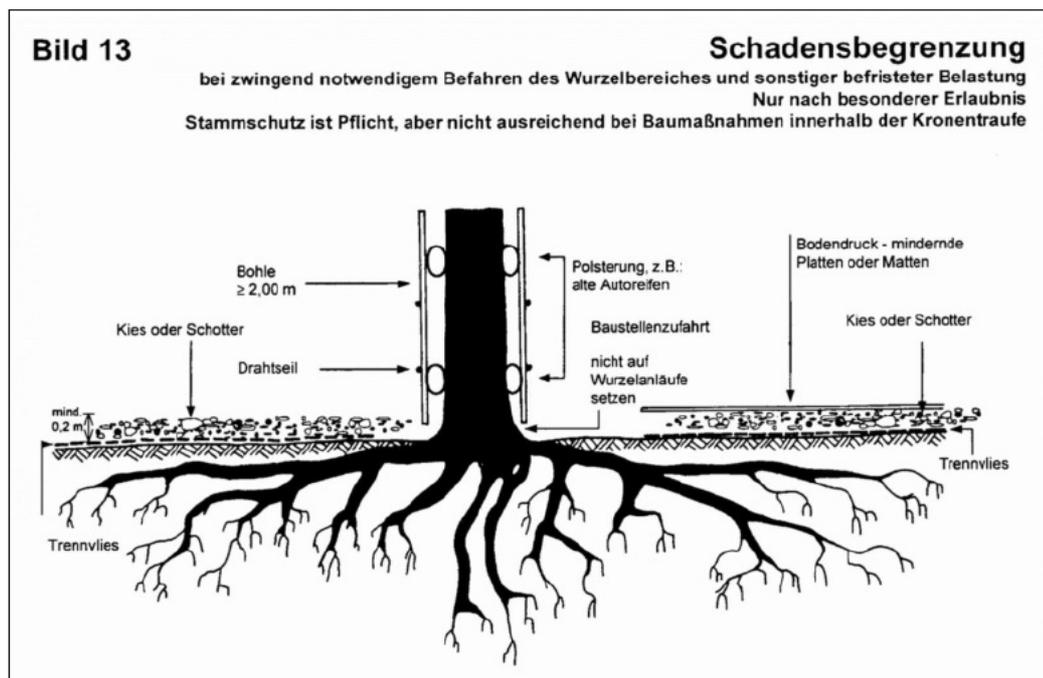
Fachgerechter Stammschutz nach DIN 18920
